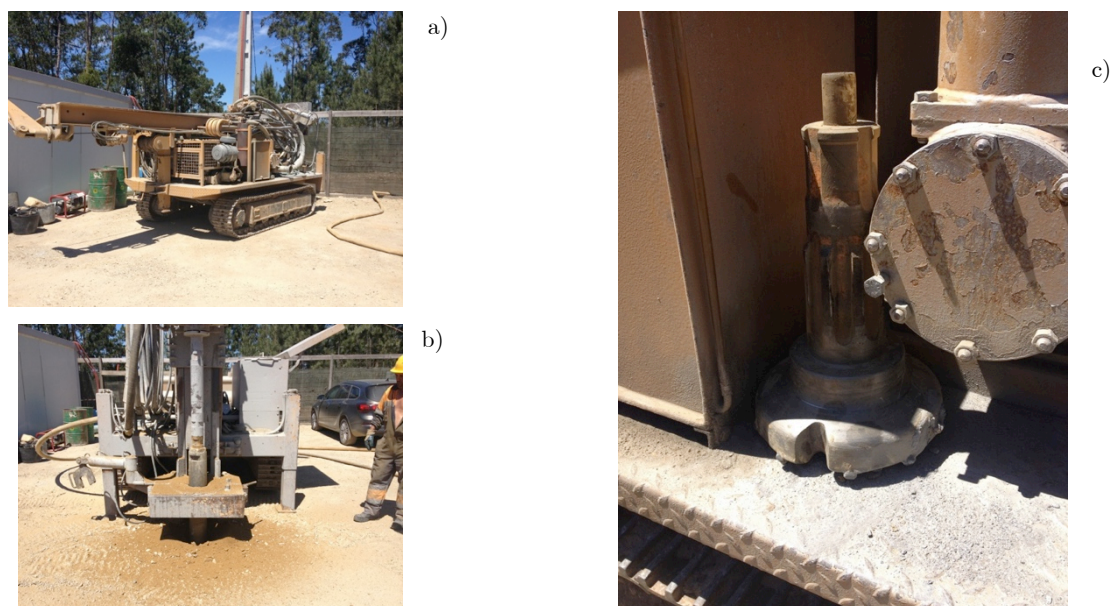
Perfuração por rotopercussão: a) equipamento de perfuração; b) perfuração; c) martelo de fundo de furo
